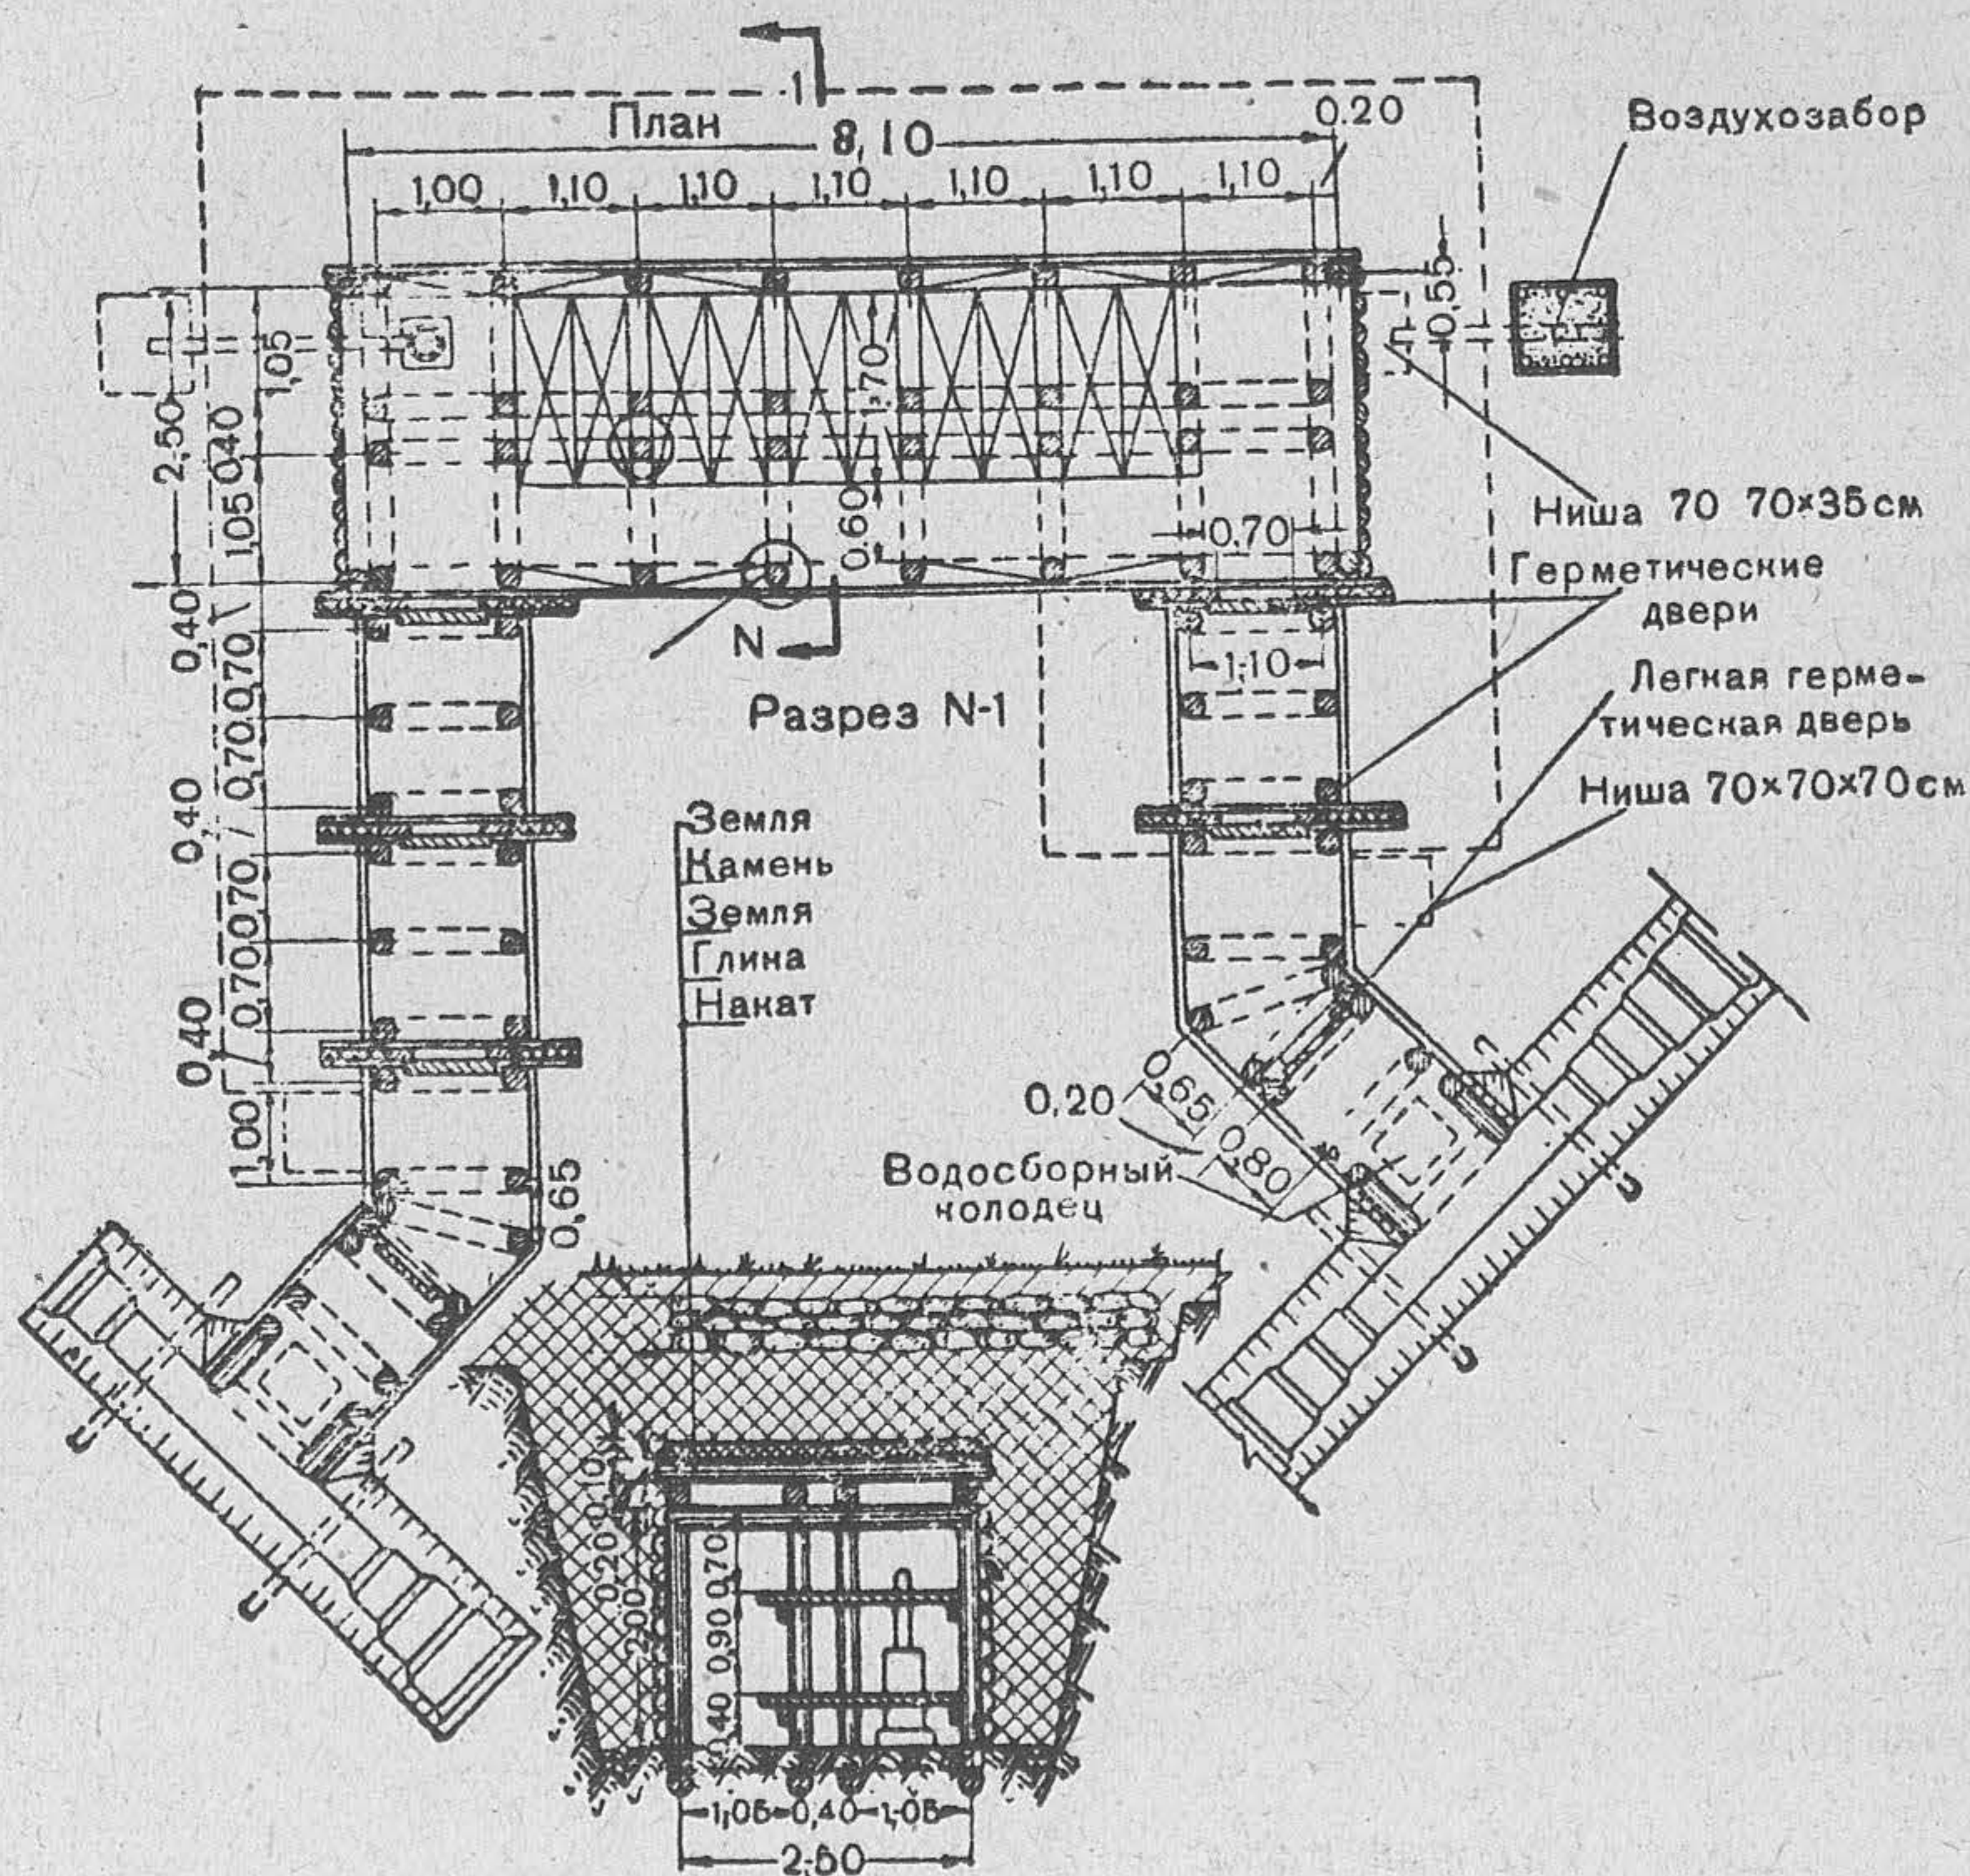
Котлованное убежище стойчатой конструкции усиленного (или тяжёлого) типа на 20 бойцов
